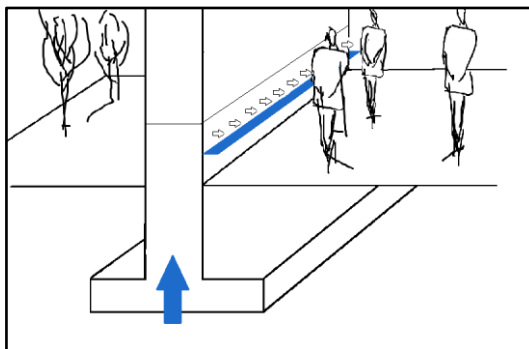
Evaporação pelo pano interior de parede acima do pavimento.
